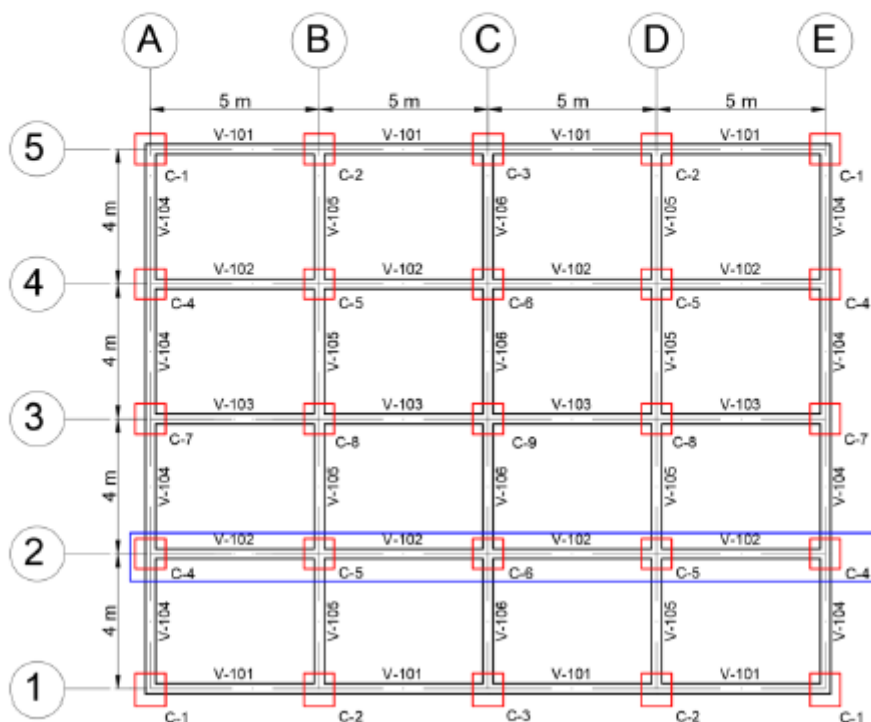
Planta típica – Sistema Estructural de Pórticos (Elaboración Propia)
